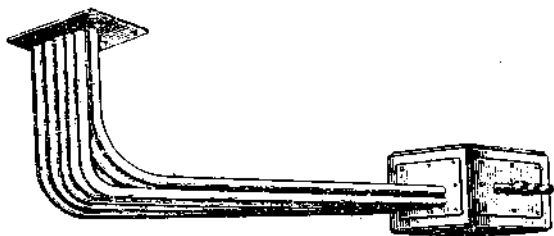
Трубный блок для питающей электросети типового крупнопанельного дома
